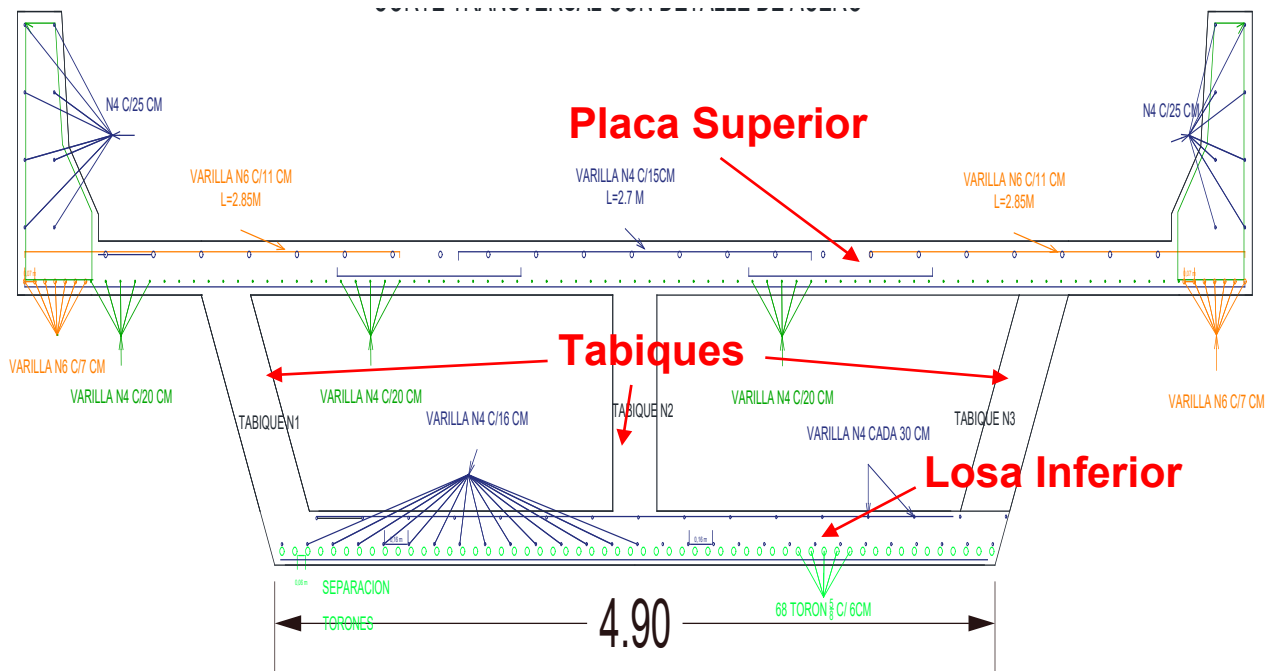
Plano detalle de acero de refuerzo de placa superior y losa inferior para dovela prefabricada de concreto.
